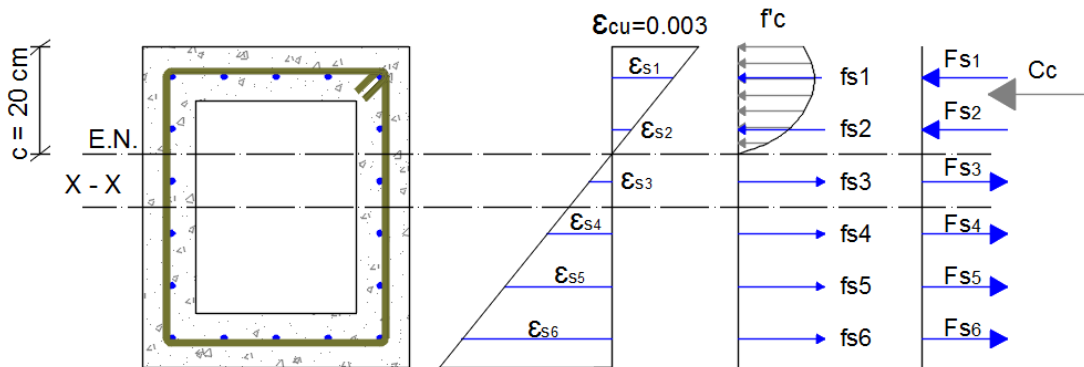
Esquema general de deformaciones, esfuerzos y fuerzas en la sección transversal rectangular
